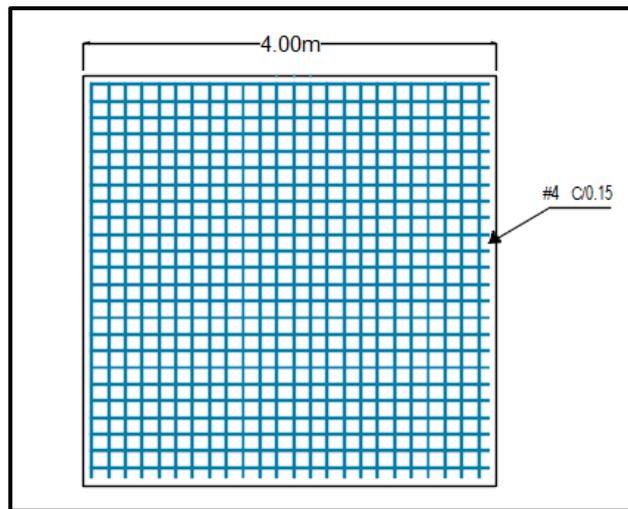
Vista en Perfil de los Muros, Vereda La Laguna
